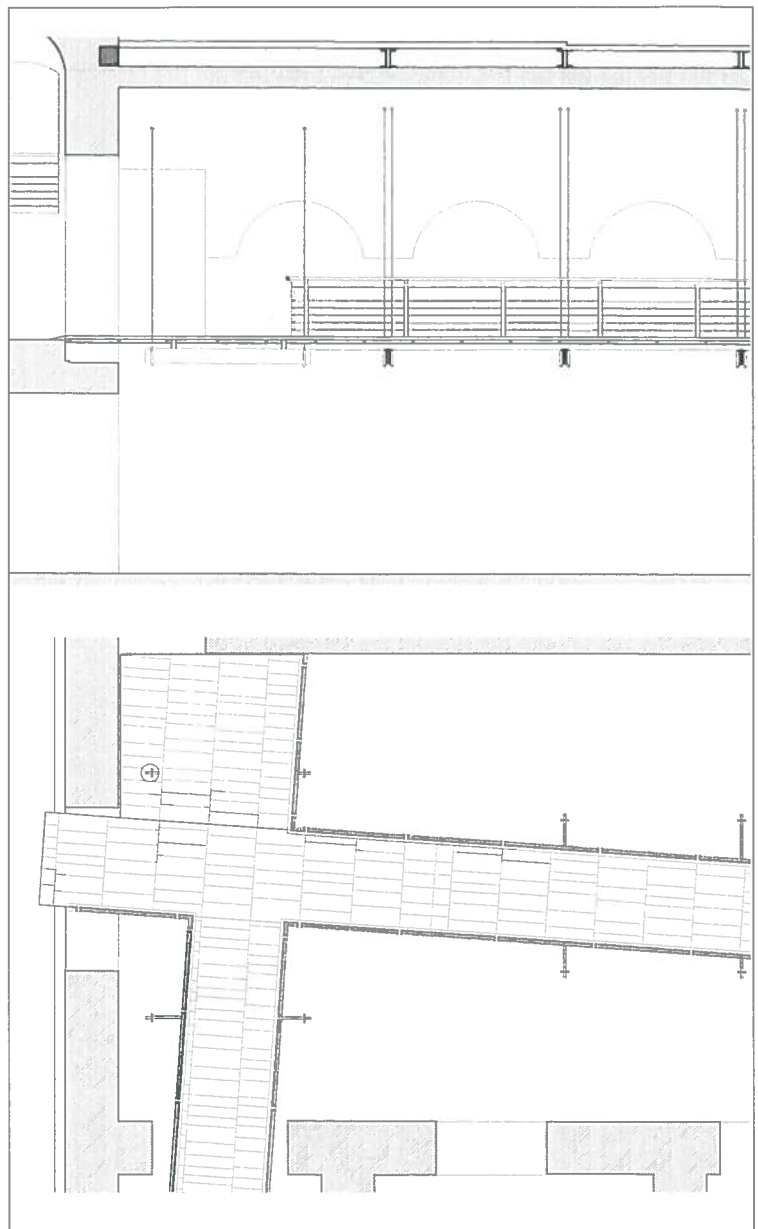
Restauro della Cartiera del Fibreno a Isola del Liri. Pianta (sotto) e prospetto (sopra) della passerella in acciaio a sospensione diretta.
